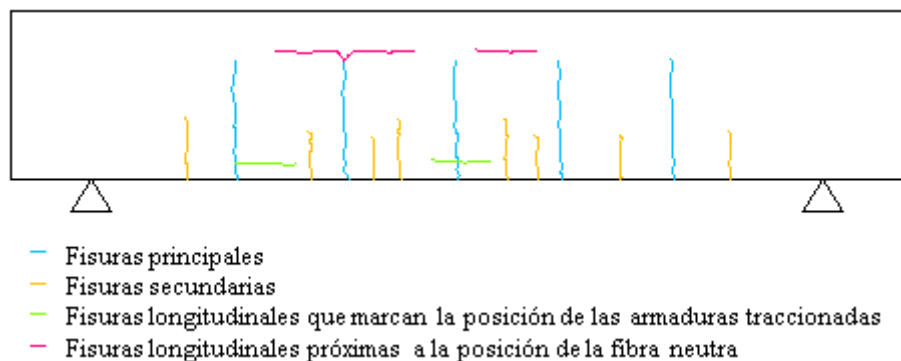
37. Tipos de fisuras en ensayo de flexión pura. [Calderón, E. (2008)]
